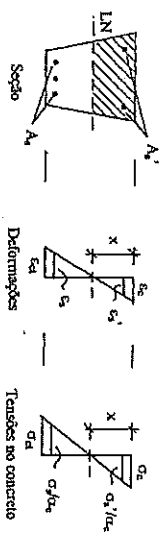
Viga de concreto armado flechada no estádio Ia
